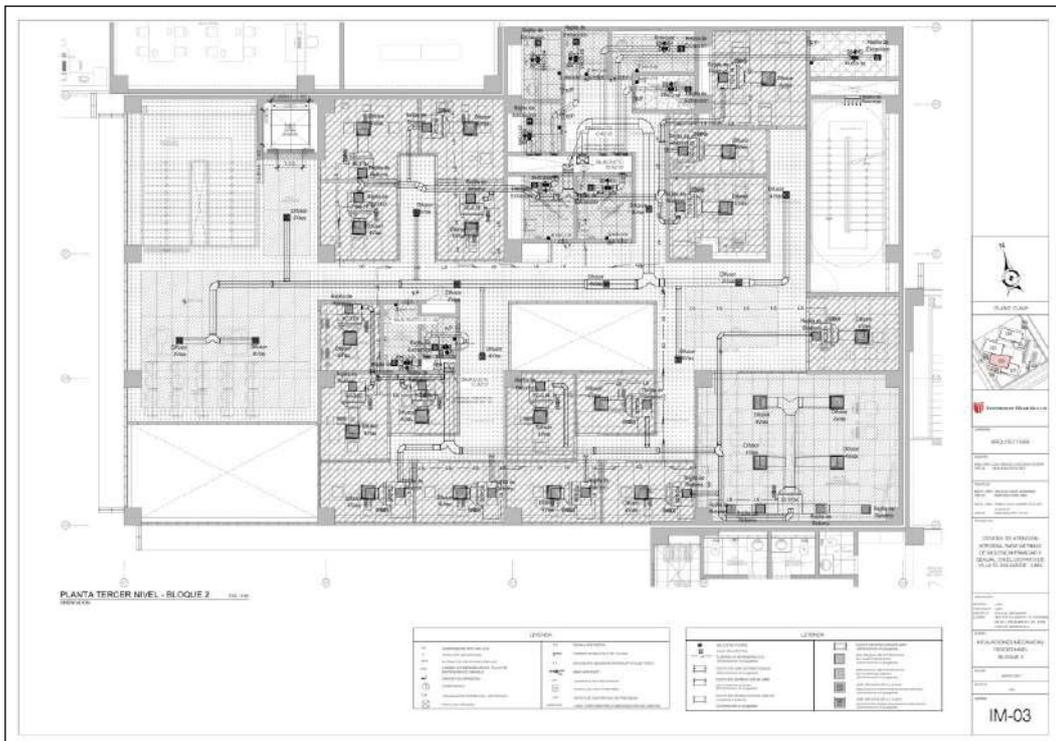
Planta tercer nivel de instalaciones mecánicas – bloque 2.
